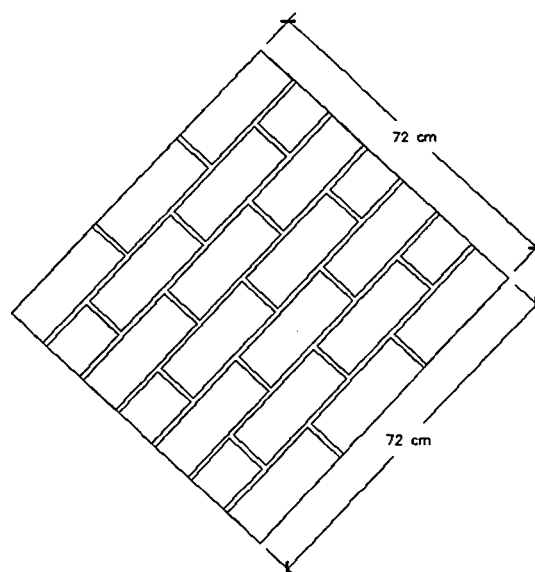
Geometría típica de los muretes de concreto y muretes de arcilla, cada murete tiene un capping de yeso de espesor variable y 1 cm de junta de mortero.
